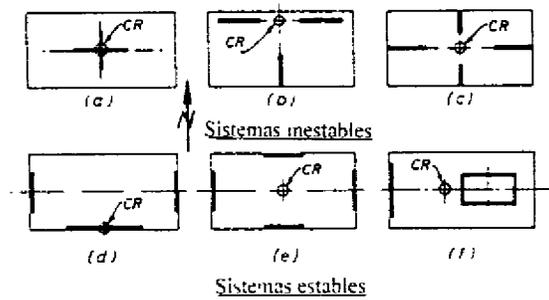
Ejemplos de estabilidad torsional en sistemas de muros estructurales
